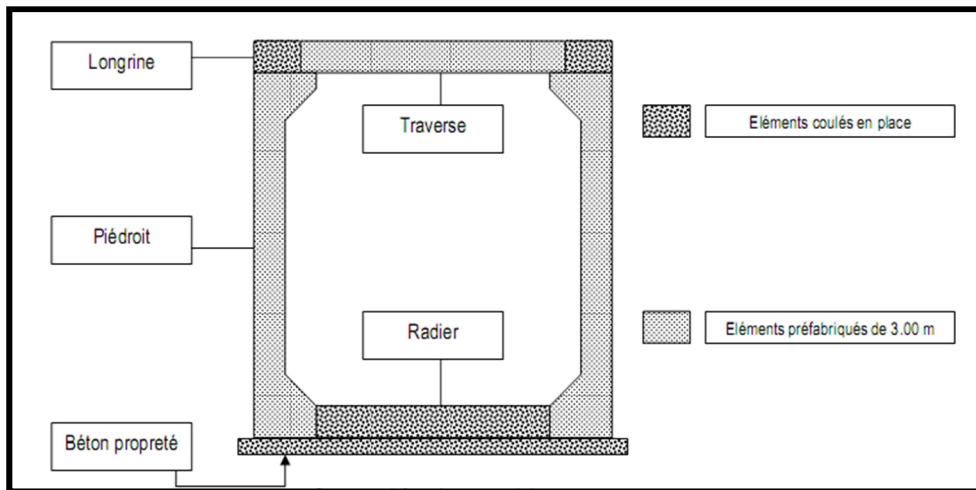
Plan des éléments constitutifs d'un dalot
